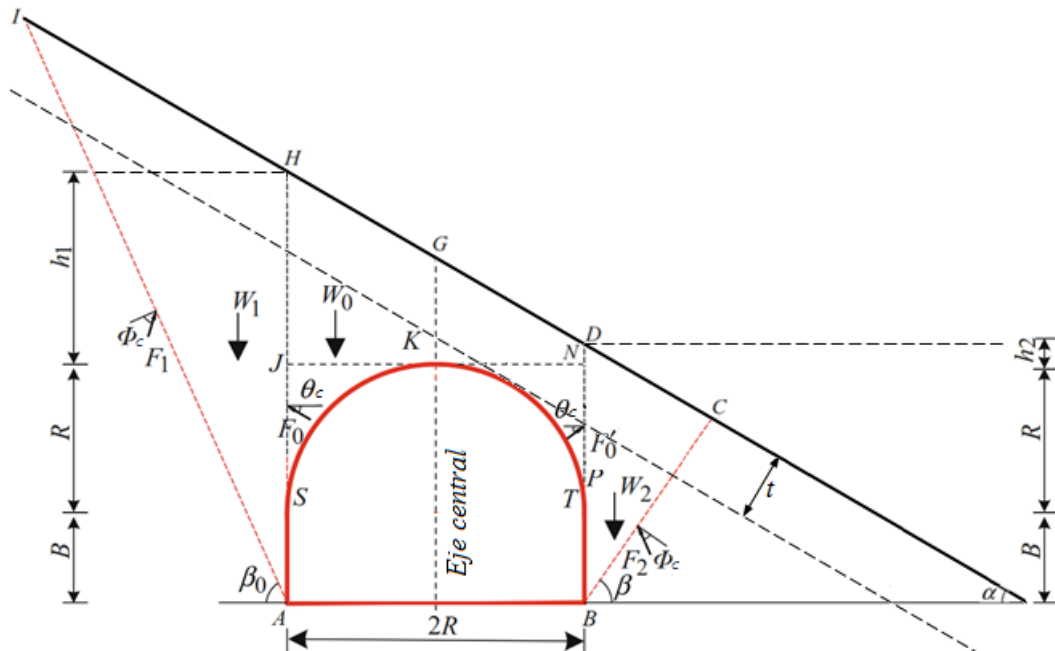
Modelo cinemático túnel de ladera modificado de Zhou, Wang & Lin (2014)
